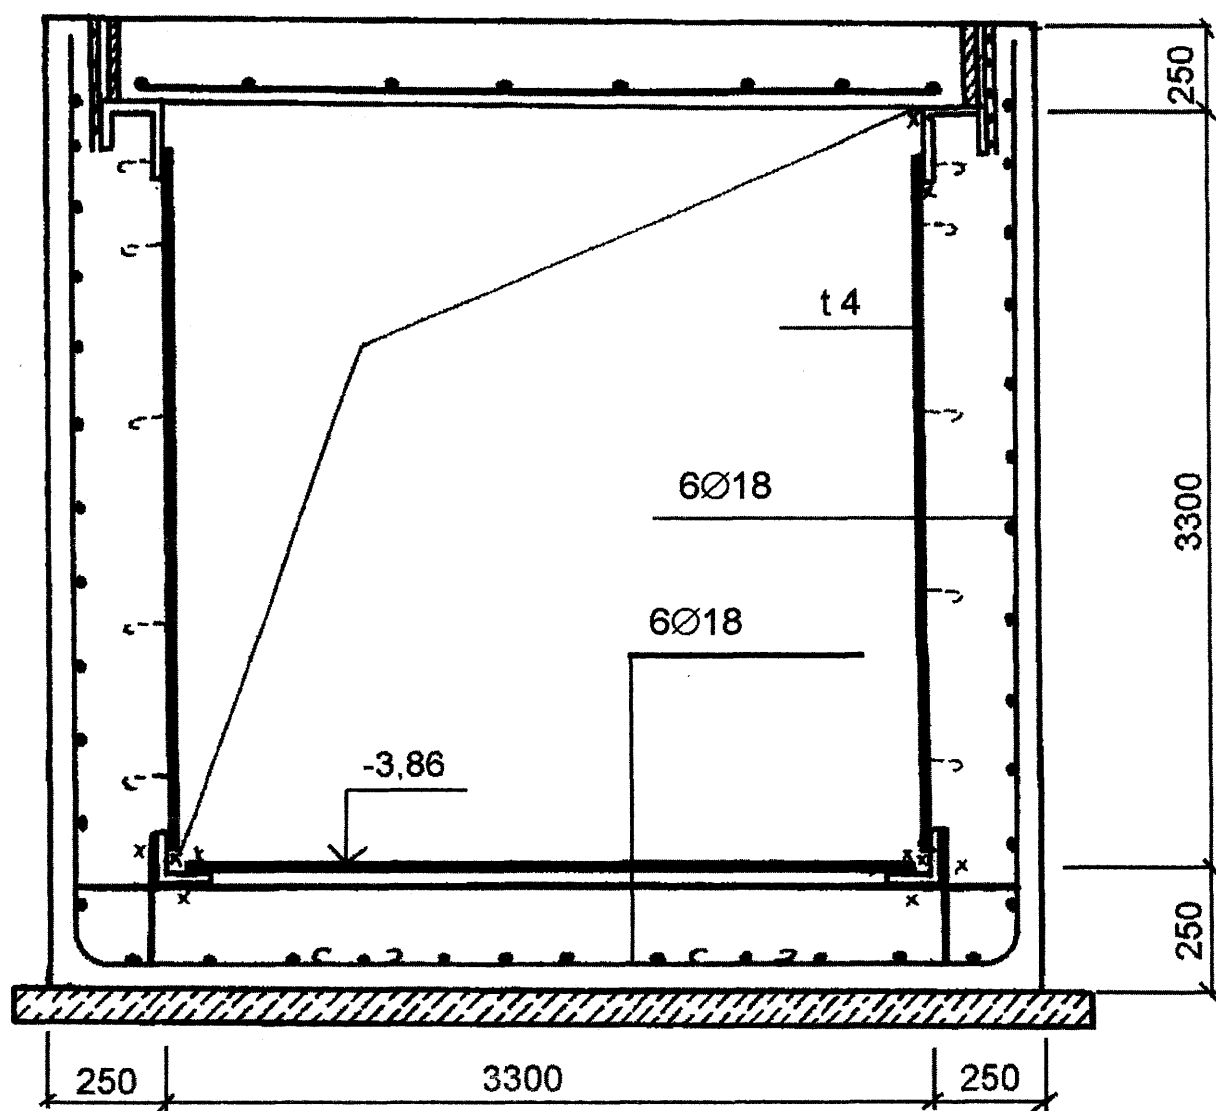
Армирование борона от печей к дымовой трубе внутренней листовой арматурой
